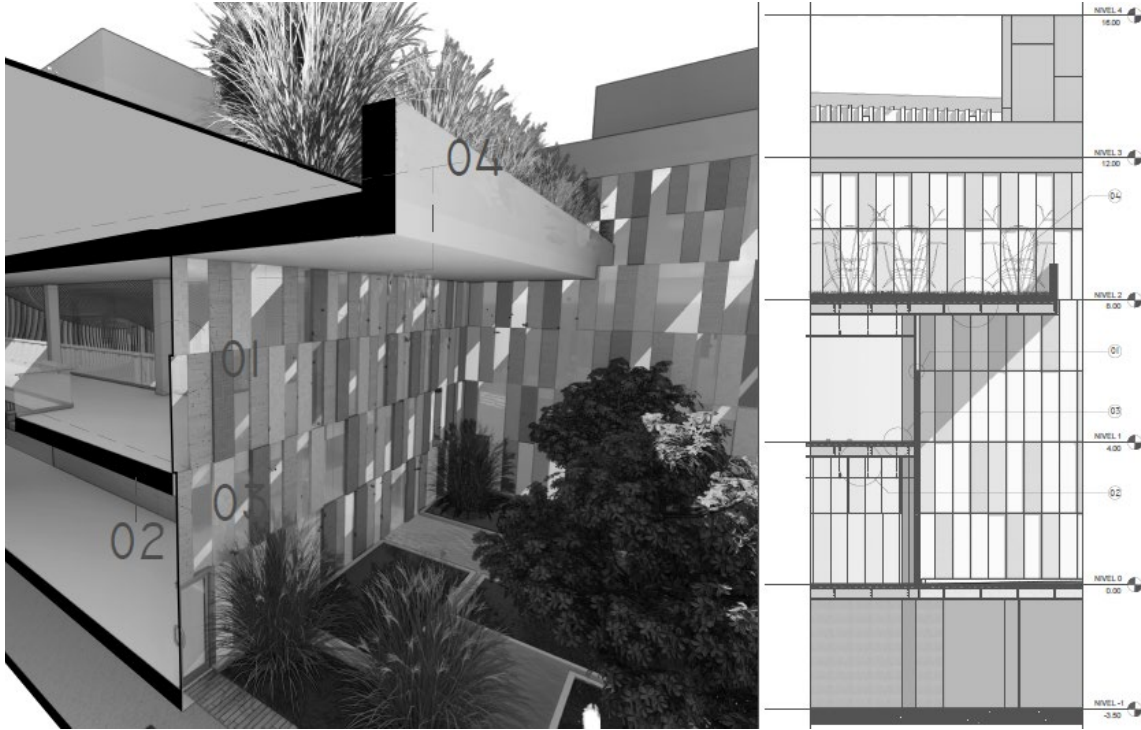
Corte Fachada. Nota: Muestra detalles internos. Elaboración propia: Photoshop
